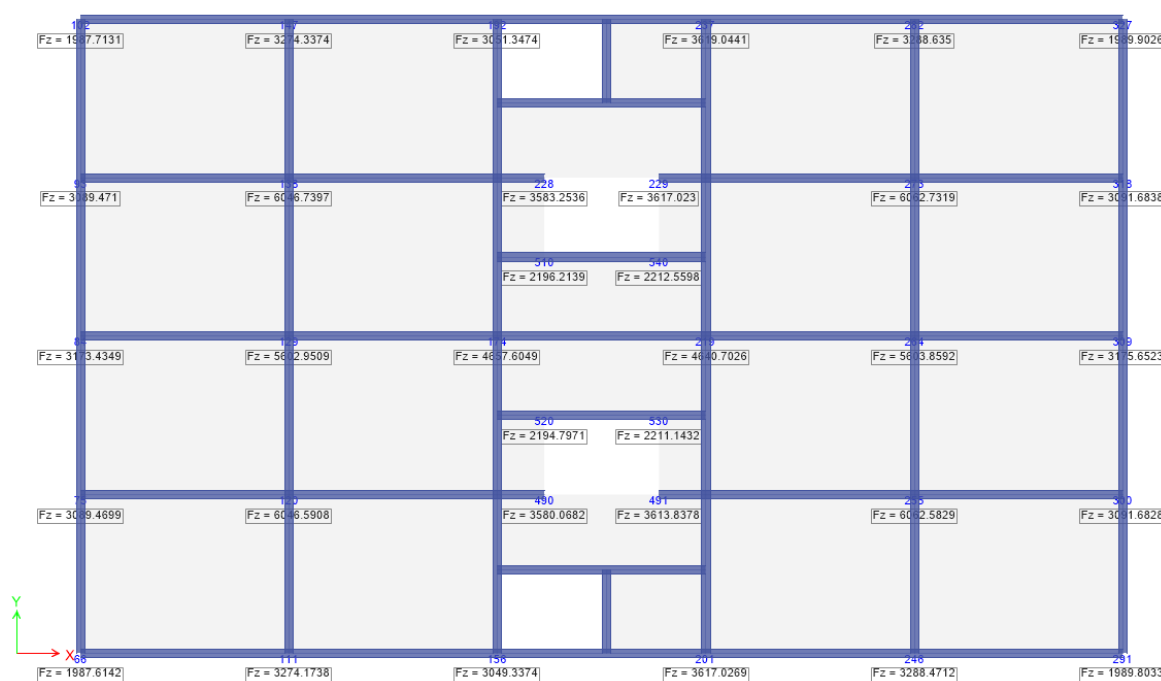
Cargas verticales (unidad kN) sobre las unidades de aislación.
